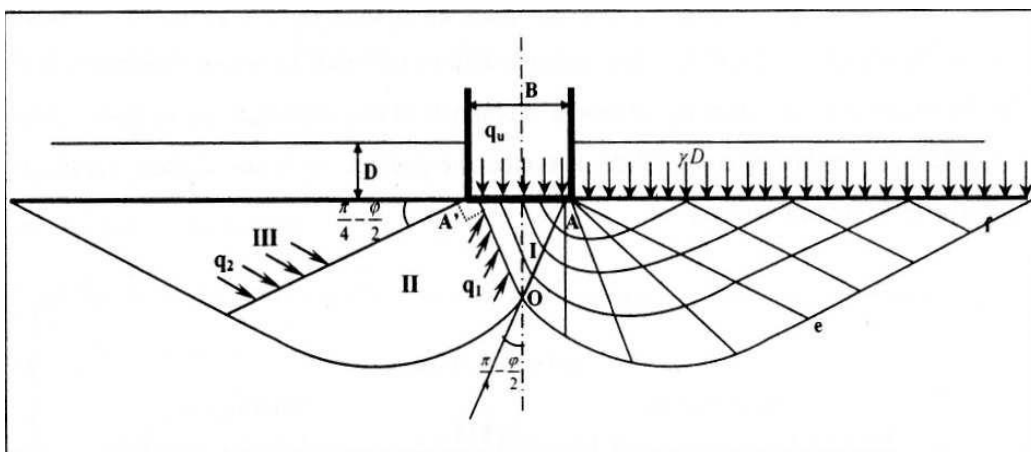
Mécanisme de rupture d'une semelle filante Prandtl (1920)
